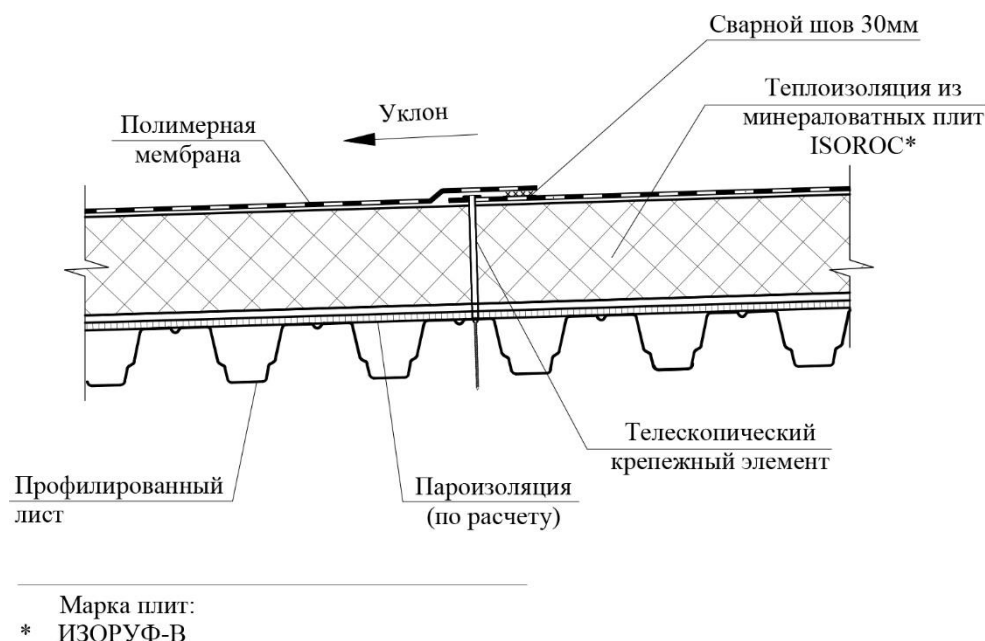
Устройство гидроизоляционного кровельного ковра из ПФХ-покрытия. «Встречный» шов».
